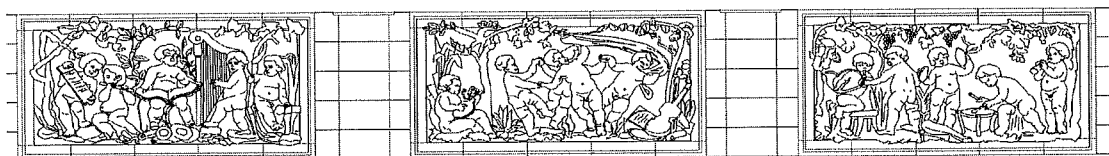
Friso central sobre acceso de calle Libertad.
